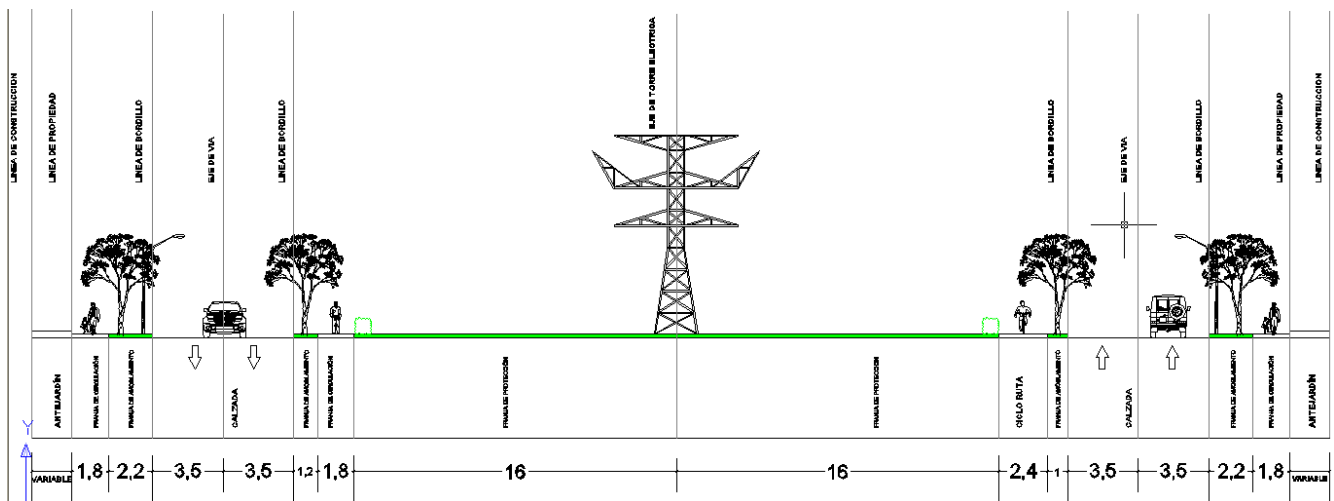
Perfil vías paralelas a franja de protección por Redes eléctrica de alta tensión.
